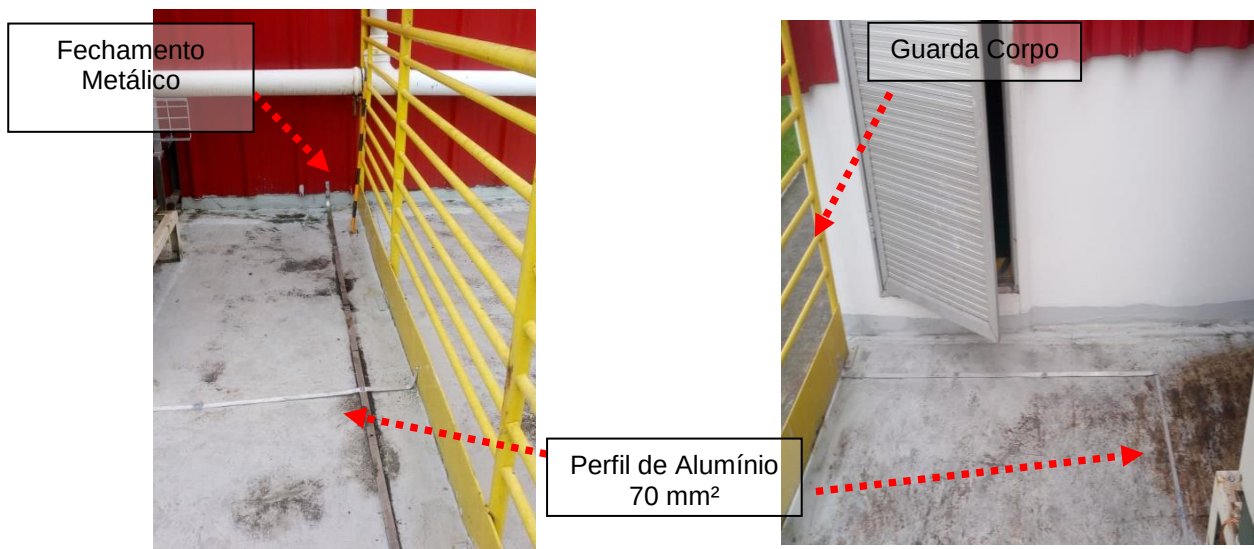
e 115: interligação malha de captação com estruturas metálicas.
